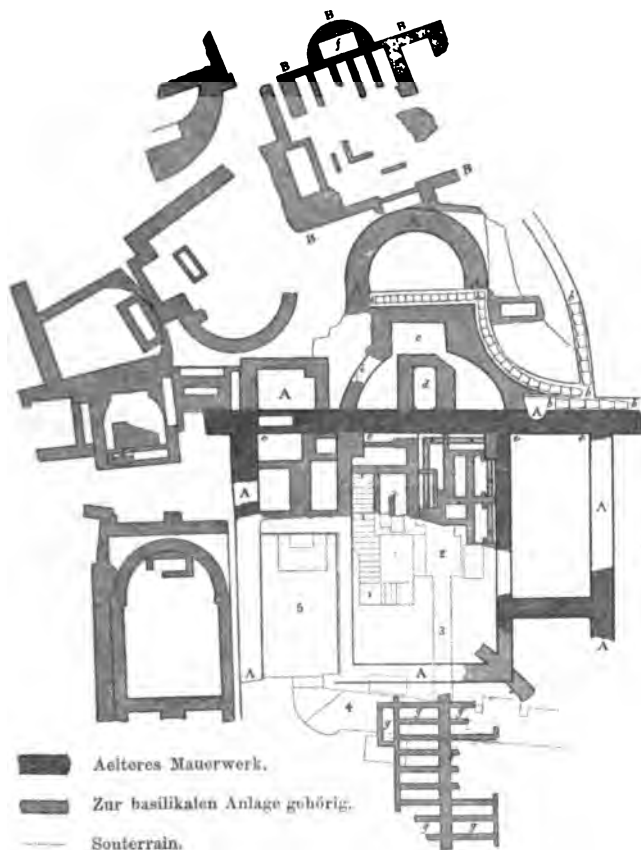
Grundriss der Basilika S. Silvestro.
